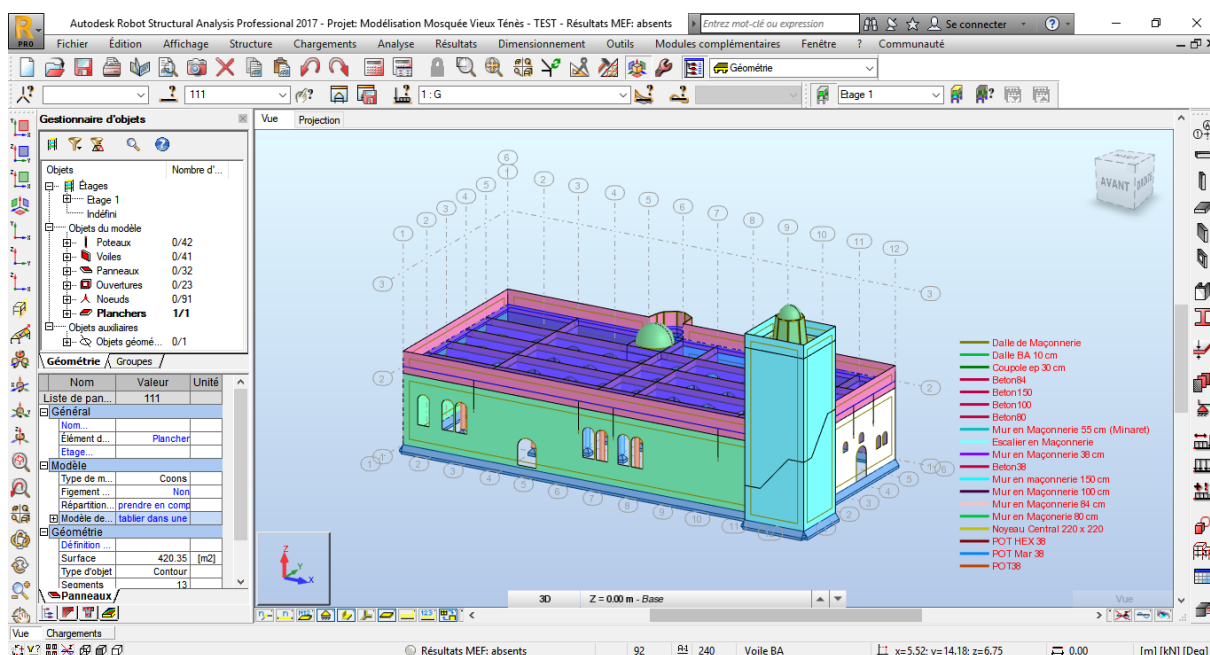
Modélisation de la dalle en béton armé (Auteur, 2018)
